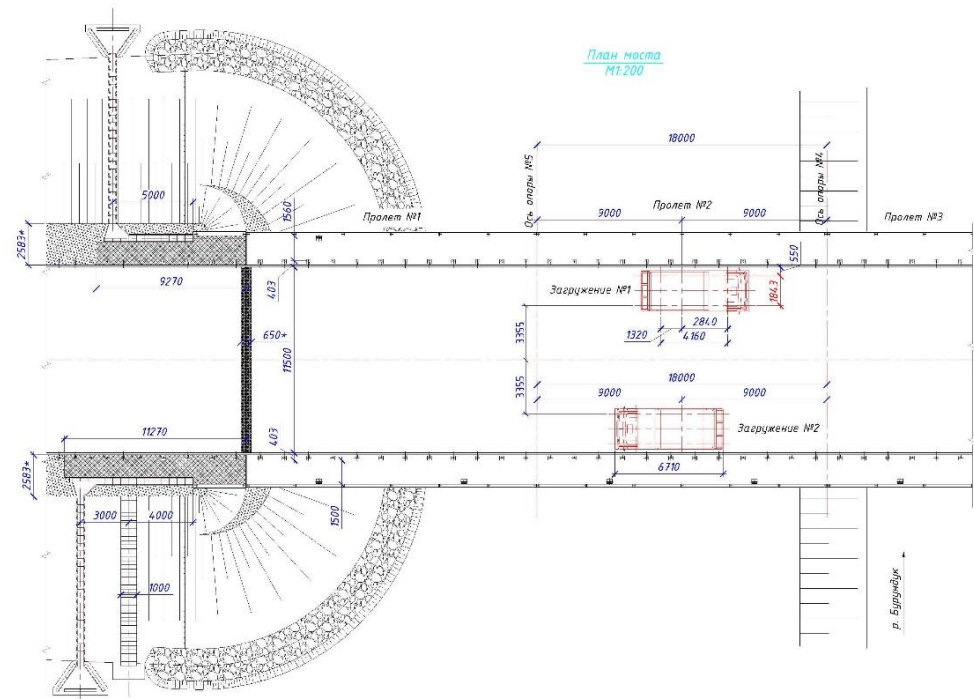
План моста со схемой расположения испытательной нагрузки в 2 вариантах загрузки. Схема выполнена А.А. Банниковым
